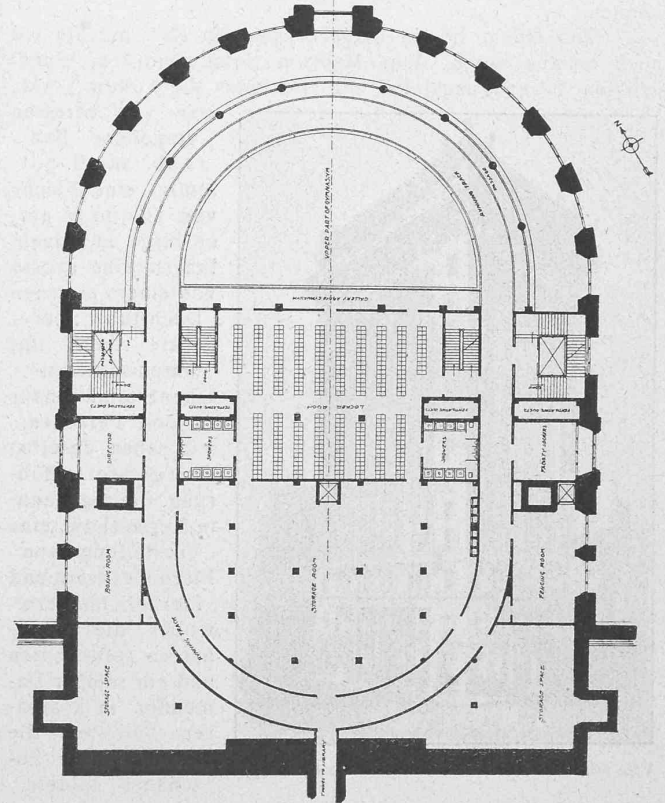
Columbia University. — Turnhalle. Grundriss vom Obergeschoss mit Rennbahn. 1 : 700.
